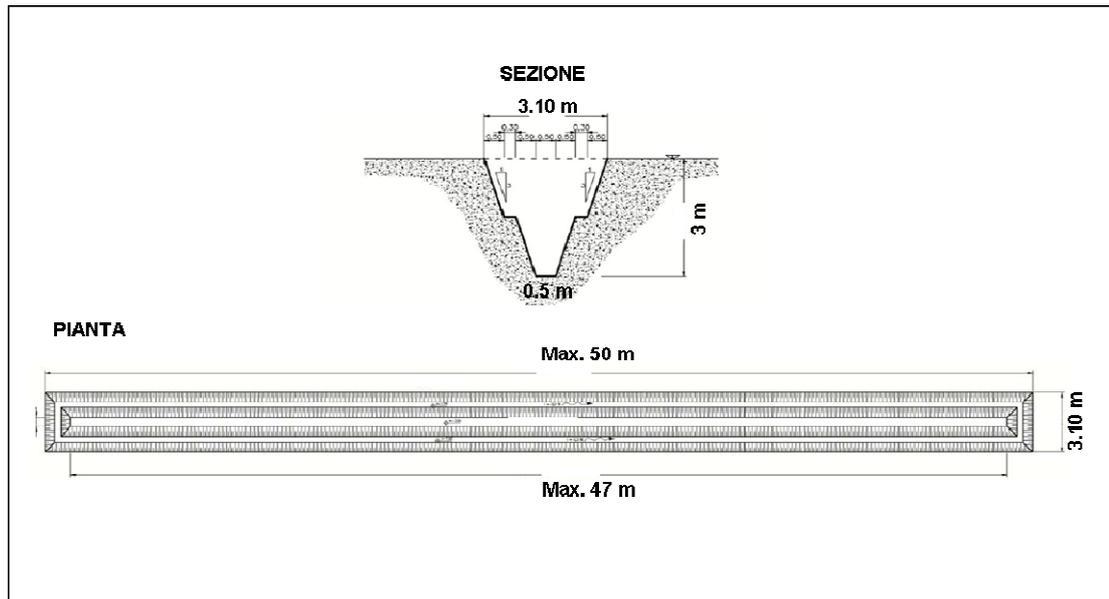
e: Stralcio del Progetto della Trincea Esplorativa del Bacino Monte Alto (Pianta e Sezione)
